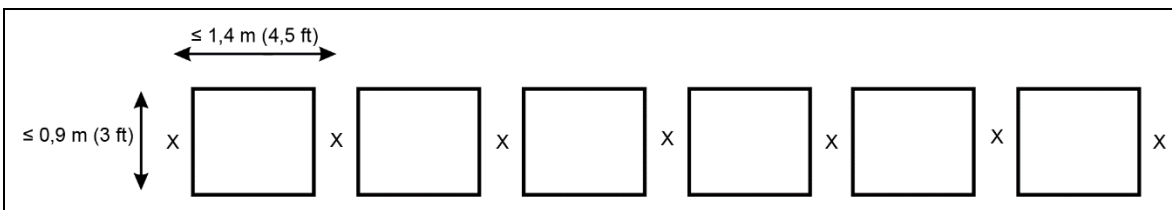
Vista en planta de una configuración alternativa de rociadores intermedios para estanterías simples con una anchura máxima de 0,9 m (3 ft)
